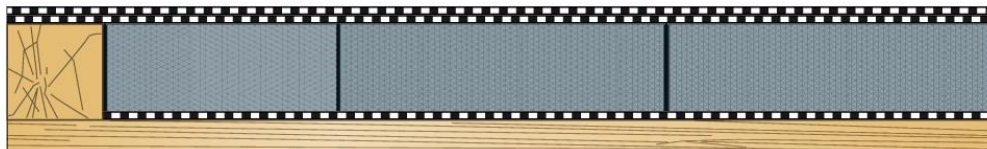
Coupe de principe sur rive avec butée en bois, sur élément porteur bois - panneaux à base de bois sous-couche ou couche de protection sur panneau bois.
